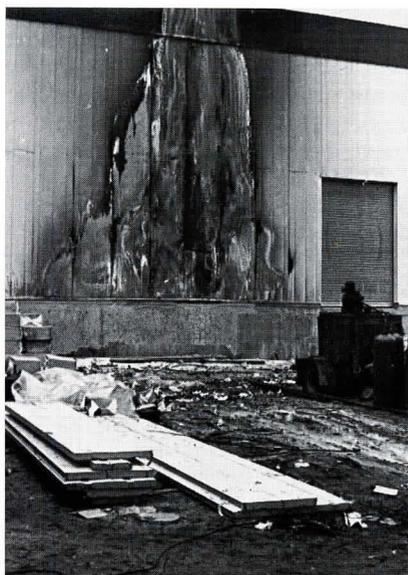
Brand vor einer Stahl-PUR-Sandwichwand
